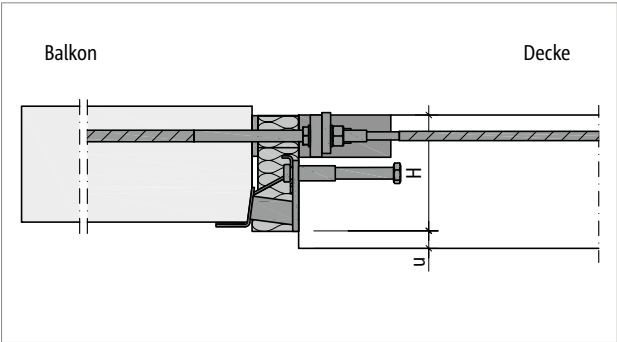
Schöck Isokorb® IQ Typ K-A: Abstand u [mm]
